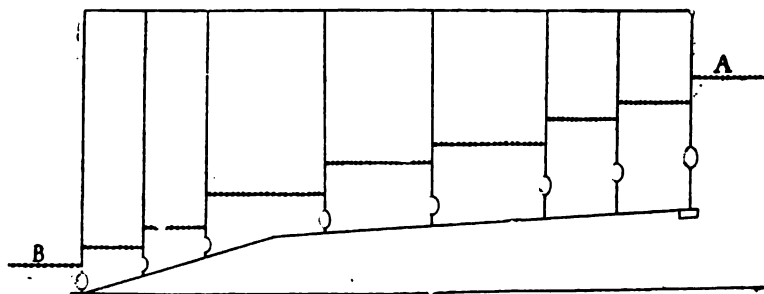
Coupe schématique d'une échelle Hockin, au barrage de Doyle, au Tiddiss.
